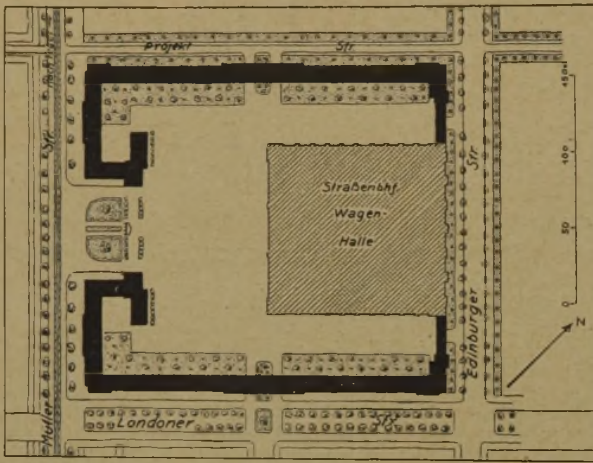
Wohnhausgruppe mit Betriebsbahnhof, Berlin, Müllerstraße. Lageplan. (1 : 5000.)
